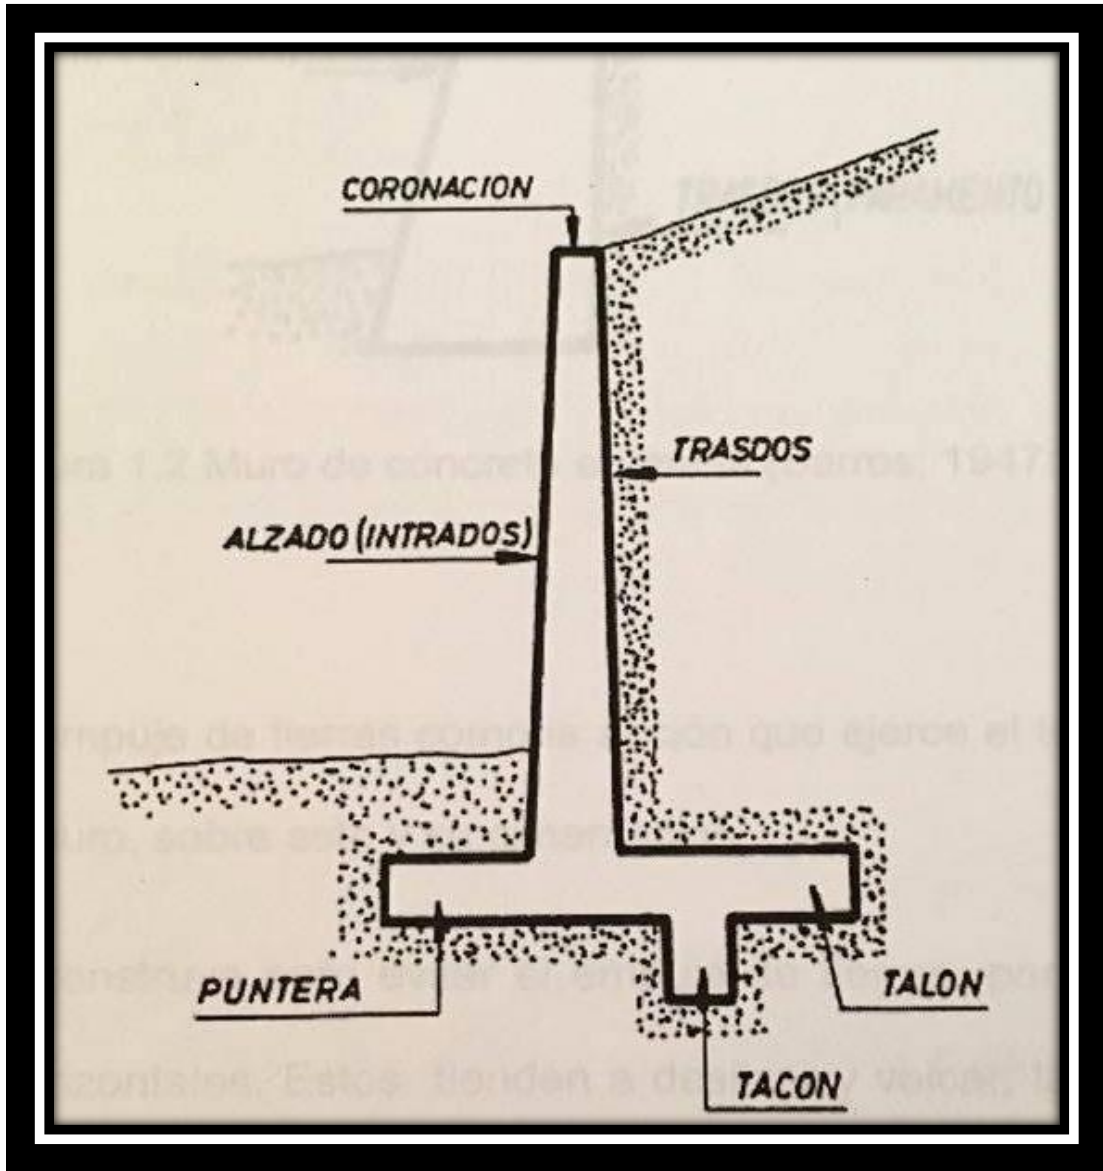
Muro de concreto armado. (Fuente: Barros; 1947:12)
